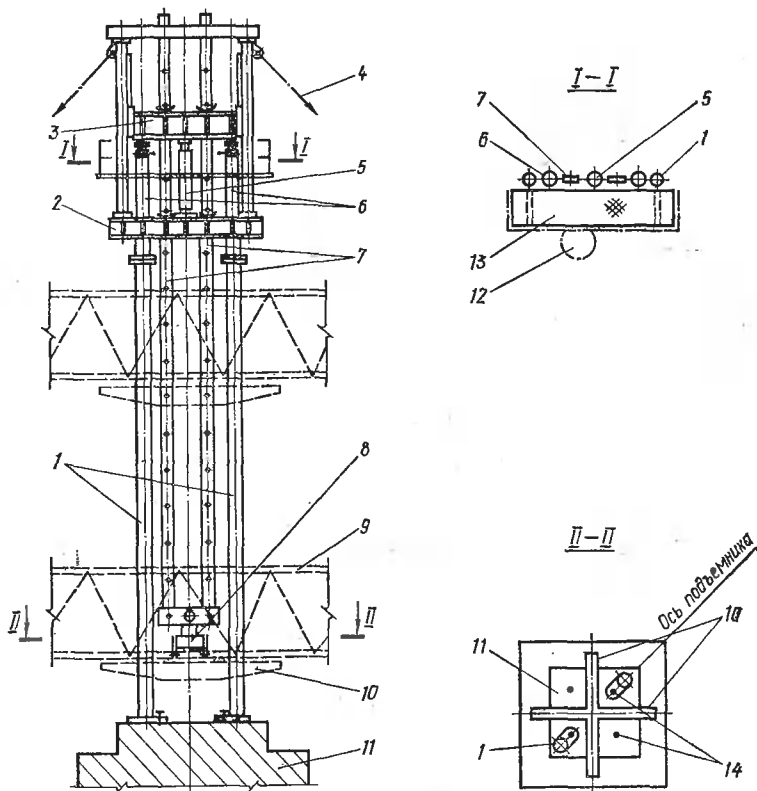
Монтаж структурной плиты покрытия гидроподъемной установкой:
